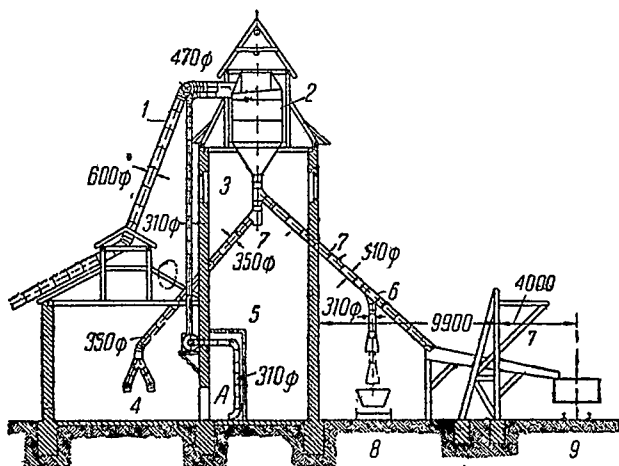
Распределительное устройство для подачи опилок в котельную и на вывоз. 1—нагнетательный трубопровод, 2—отделитель, 3—распределительная заслонка, 4—котельное помещение, 5—опилочный силос, 6—переключающаяся заслонка, 7—деревянный жолоб, 8—телега, 9—вагон.
